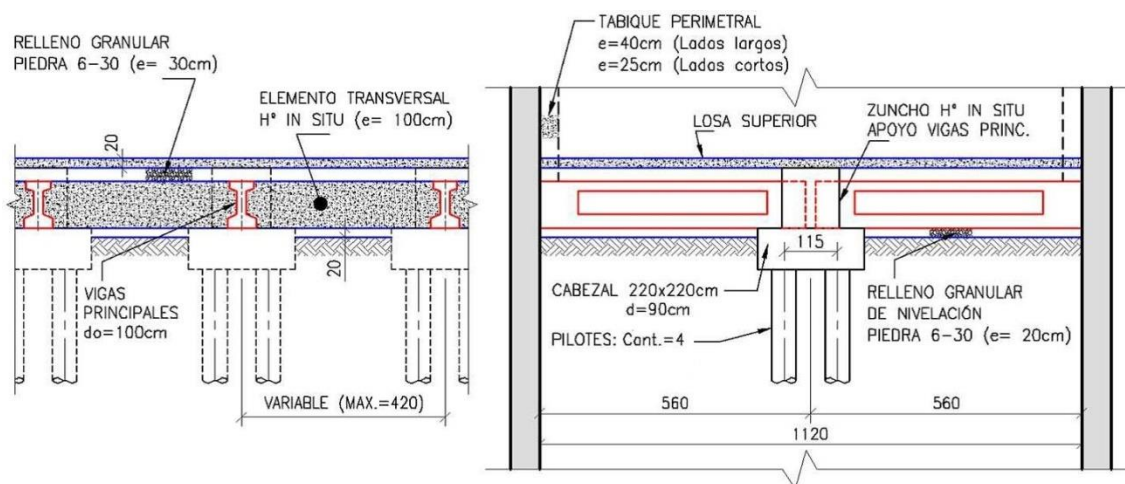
Corte Longitudinal y transversal preparación del fondo
